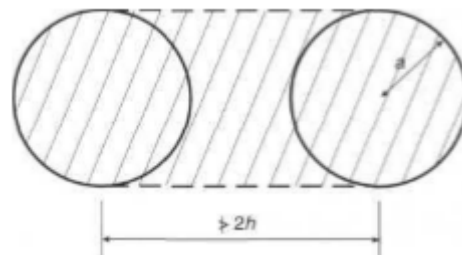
Cálculo da área de contacto equivalente para duas cargas pontuais adjacentes [Adaptado 14]
